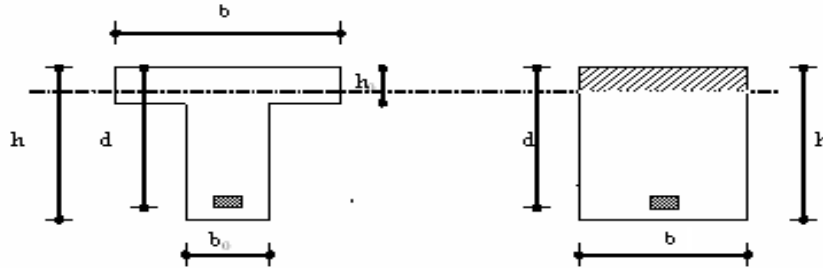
Section rectangulaire d'une poutrelle en flexion.
